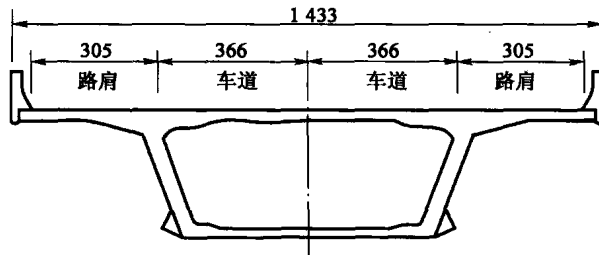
第一阶段的两车道箱梁结构断面示意图(尺寸单位:cm)
